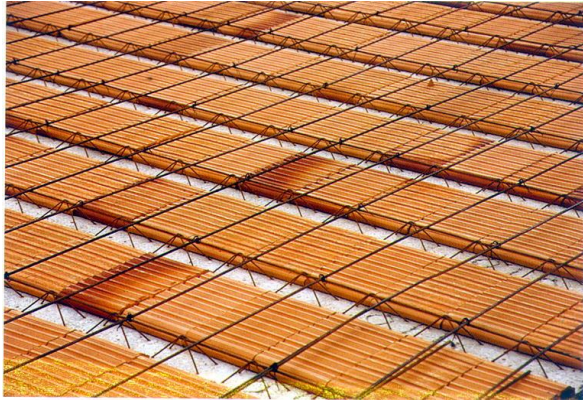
Exemplo de laje nervurada pré-fabricada do tipo treliçada (FONTE: FAULIM, 2004).
